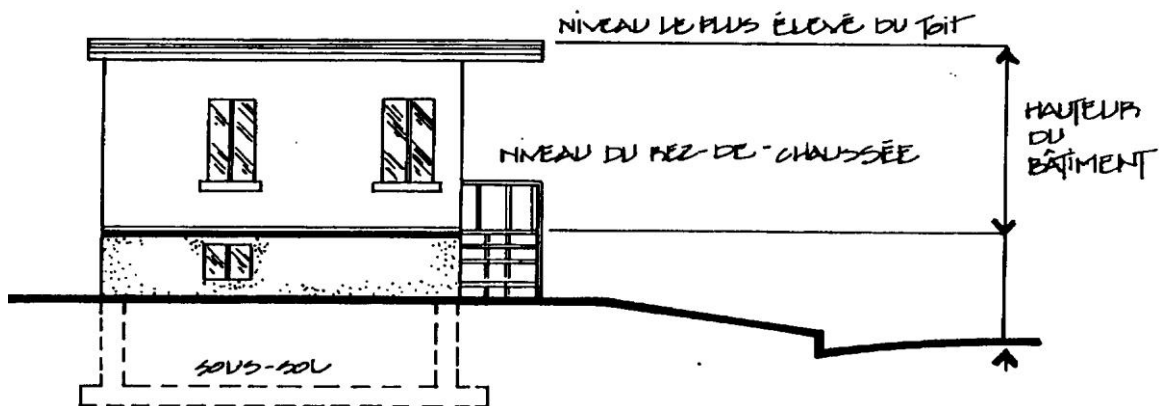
Hauteur minimale et hauteur maximale – cas 3
